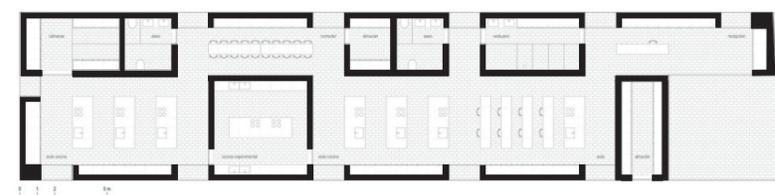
Planta del proyecto Modificado en base de (Montes,2018)
